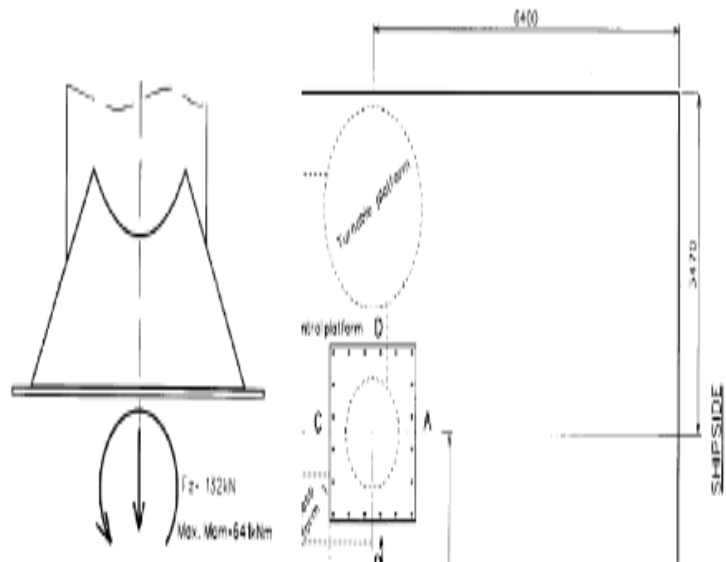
Cargas de Escalera y Ubicación. (GANGWAY)
